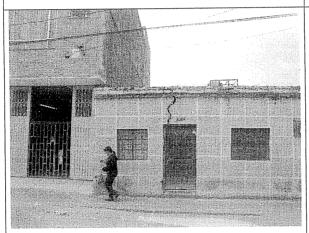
Estado actual de la fachada del inmueble ubicado en la carrera 111 # 140 A – 51.
